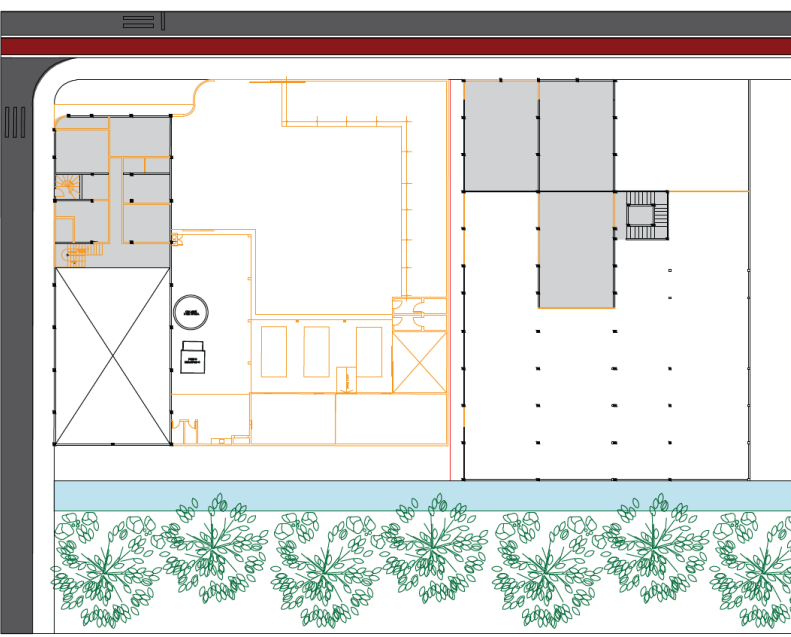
Planta baixa reforma | 2º Pavimento - Situação atual
